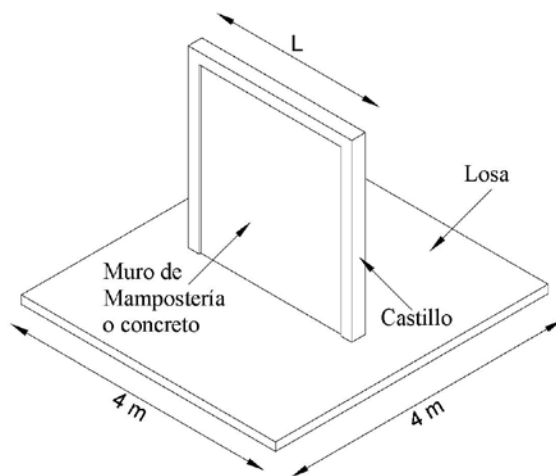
Modelo losa-muro con muro de mampostería o concreto
